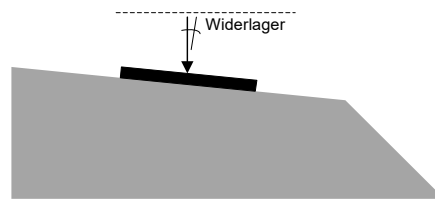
Schemaskizze zur Durchführung des statischen Lastplattendruckversuchs auf geneigter Oberfläche mit angepasster Lastrichtung
